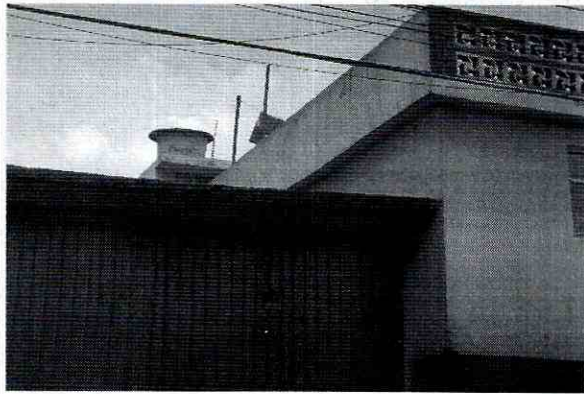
Muros de la construcción de la zona frontal en buen estado.
